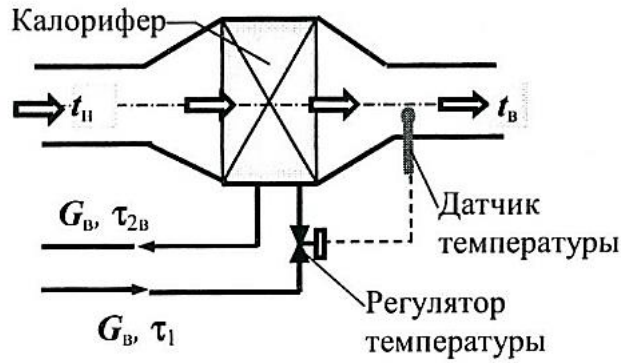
Схема регулирования нагрузки вентиляции «по воде»
